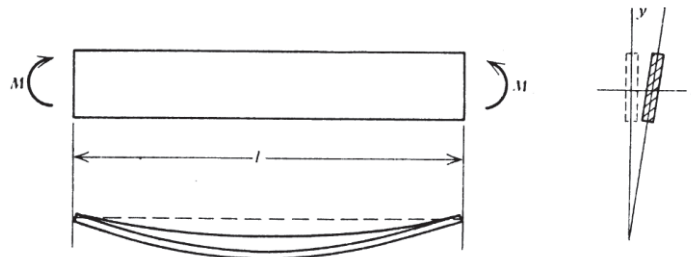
Inestabilidad lateral de viga (Park y Paulay, 1983)
